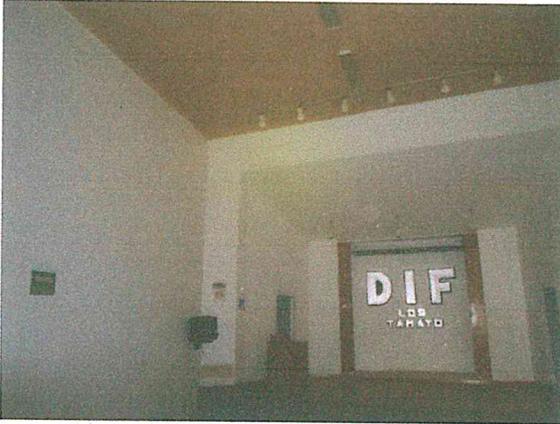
Muros y losa del auditorio, en buen estado estructural.
